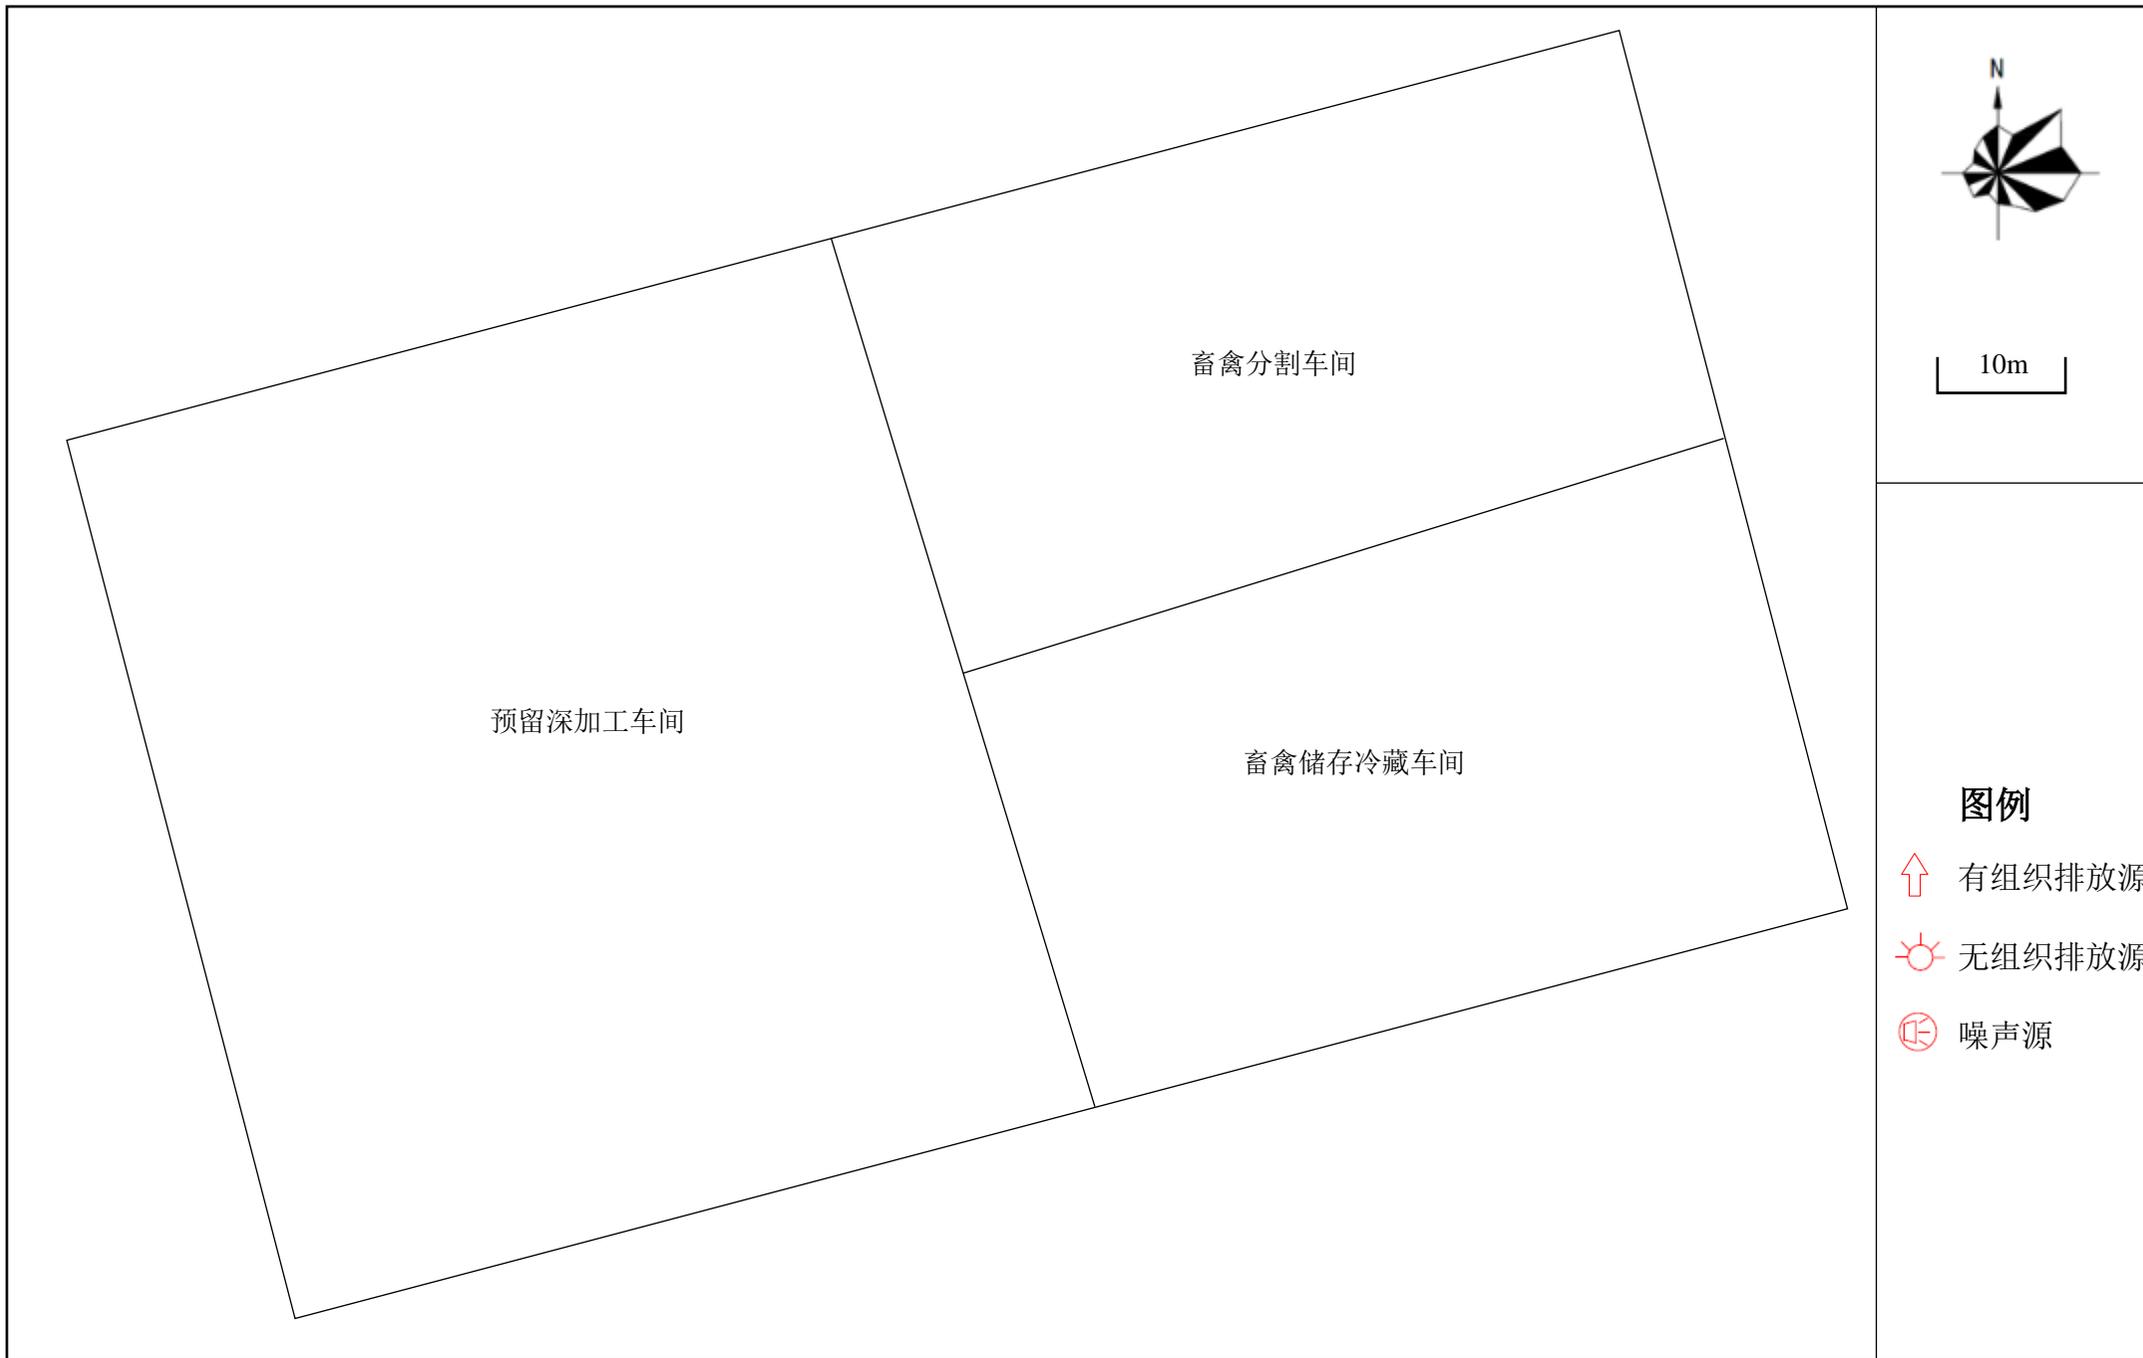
本项目建成后全厂屠宰车间平面布置图（2F）
